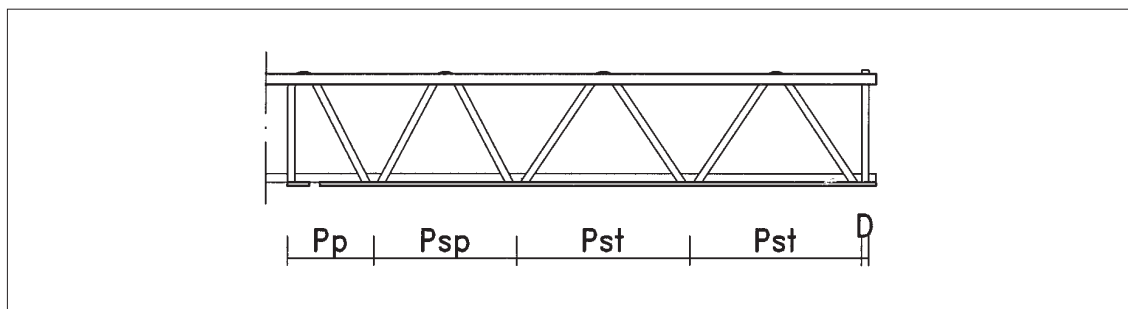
Disposizione passi sbalzo con fondello in acciaio.
